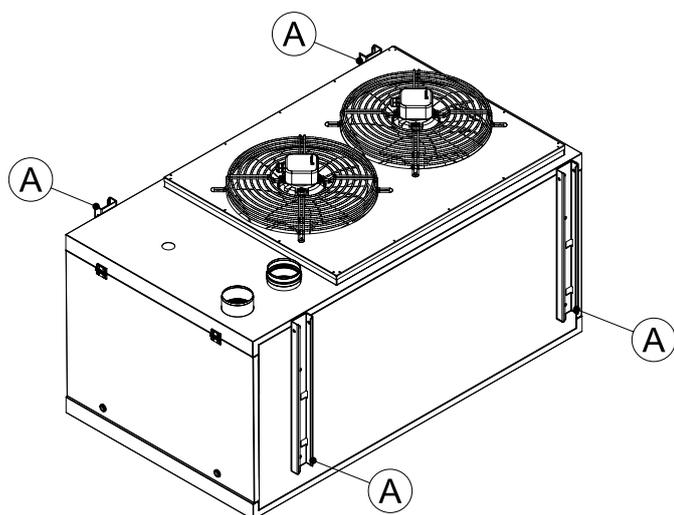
Apparecchio predisposto per l'installazione sospesa a soffitto
